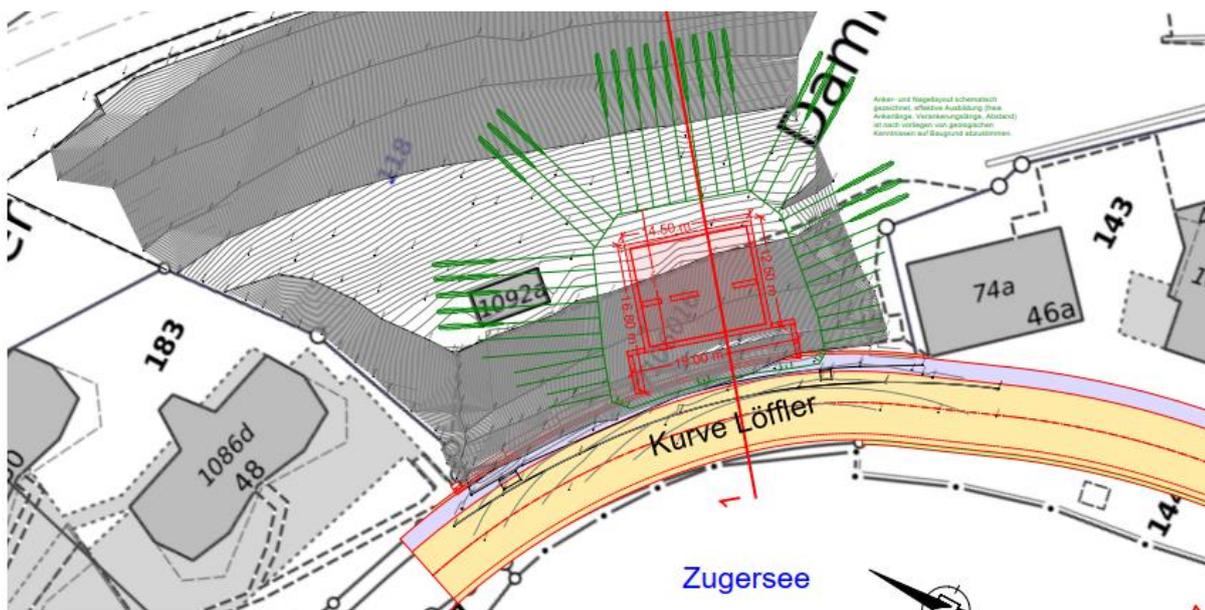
Grundriss des Betriebsgebäudes (Quelle: Basler &amp; Hofmann AG, 2024)
